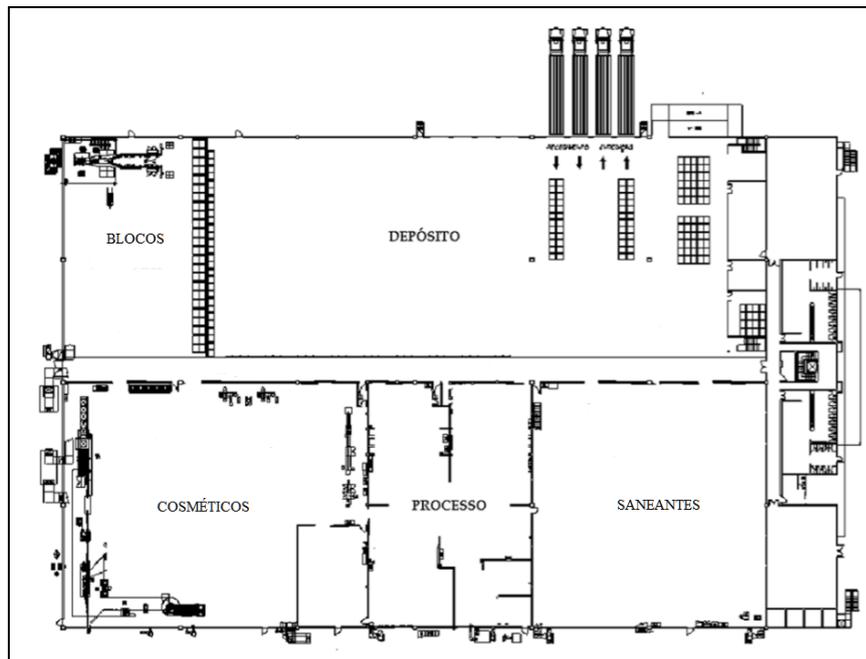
Planta baixa da Fábrica - Manaus. Fonte: Autores.
